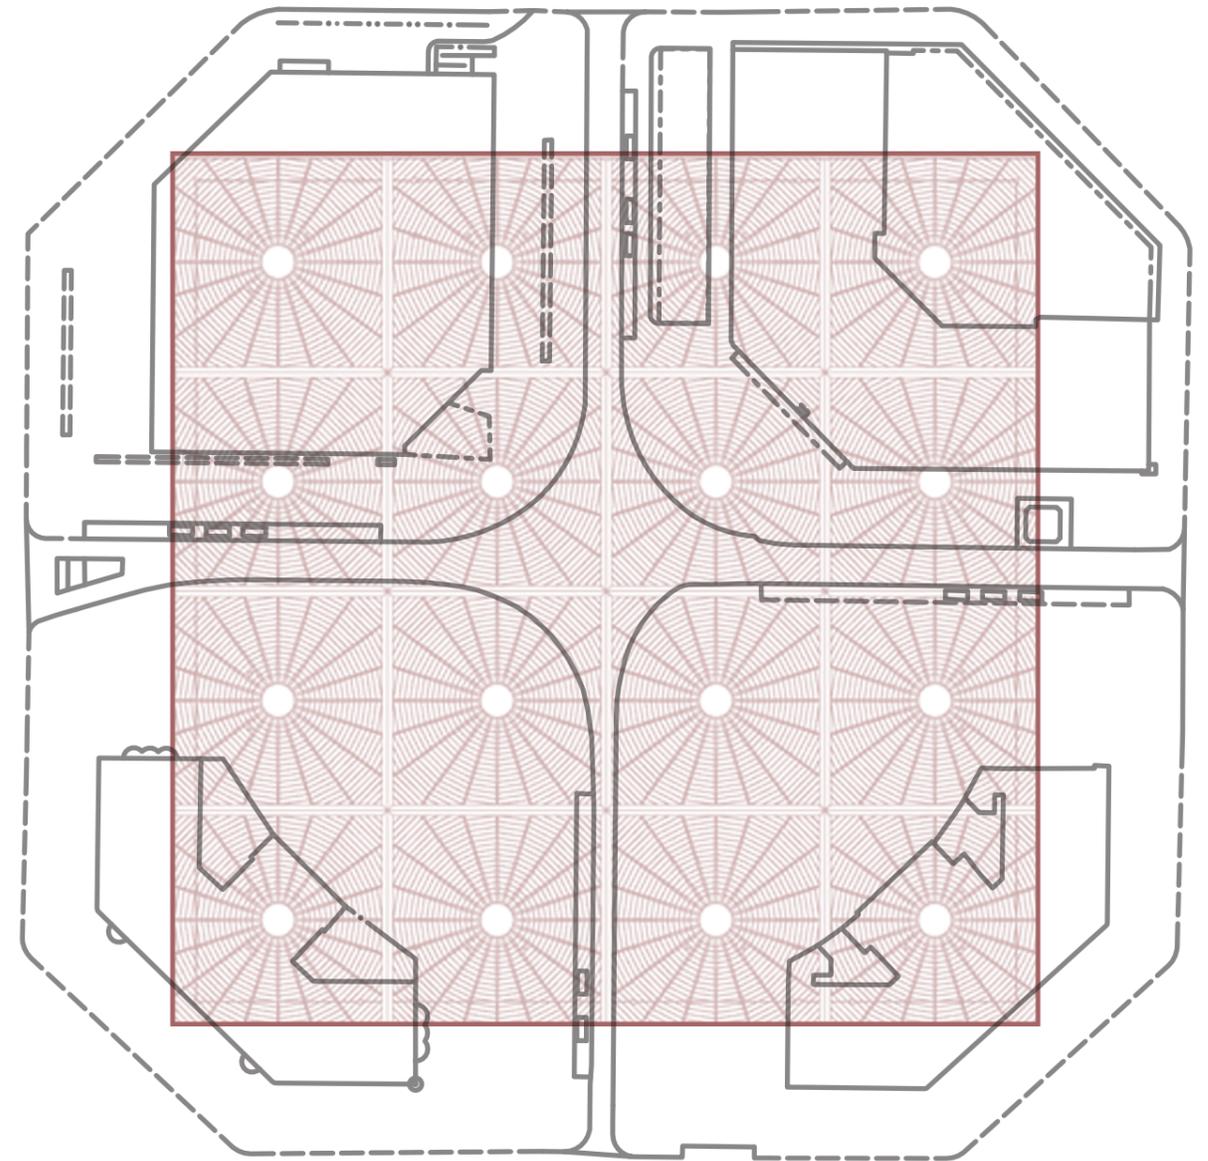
Sovrapposizione pianta Palazzo del Lavoro a confronto con l'ortofoto di Piazza della Repubblica, elaborazione degli autori.
